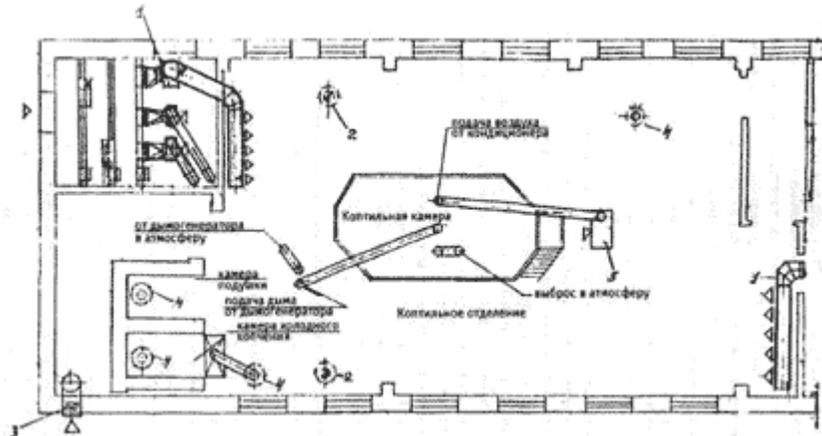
Вентиляция коптильного отделения: 1 — приточная система; 2 — вытяжная установка — крышный вентилятор; 3 — приточная установка — осевой вентилятор в стене; 4 — естественная вытяжная установка, над шахтой установлен дефлектор.
